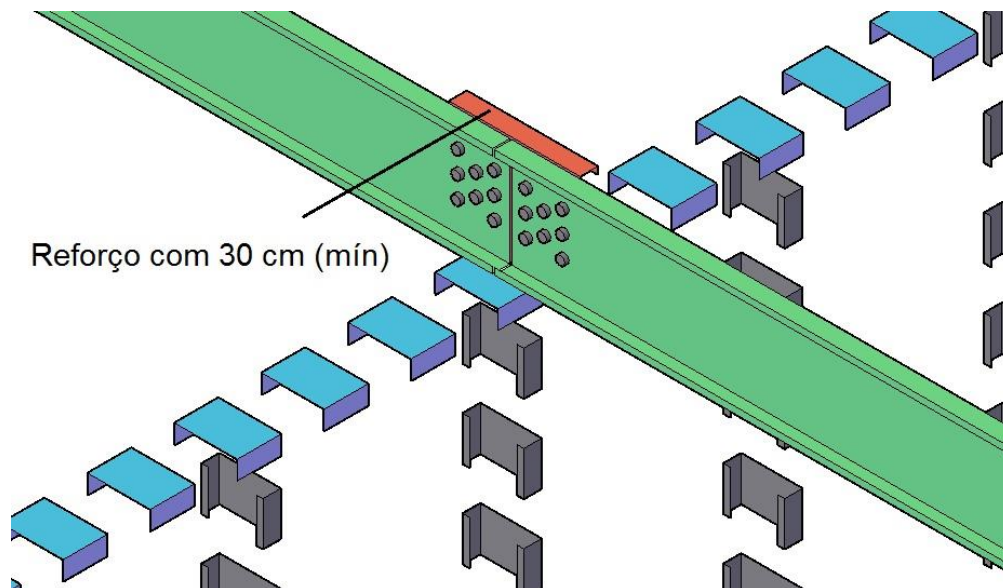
Pormenor da ligação entre vigas na cumeeira
